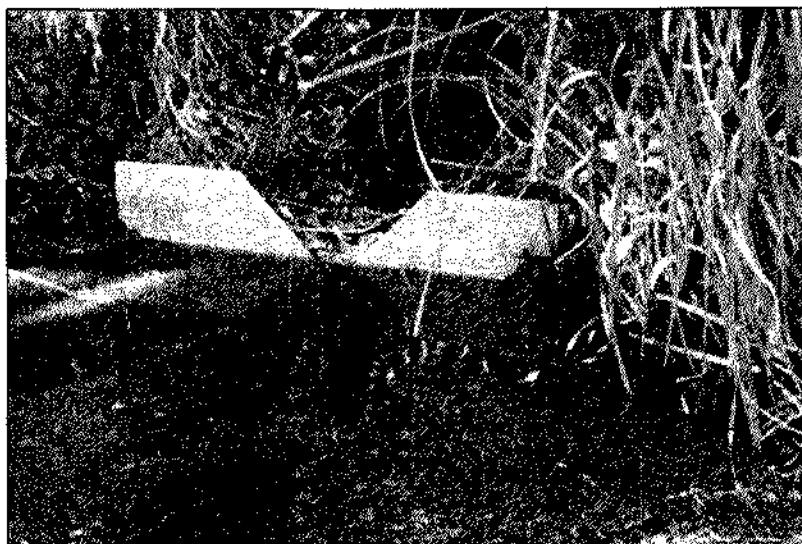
Vista tubo PVC descarga seca Vertiente Fundo Viña del Cerro.
